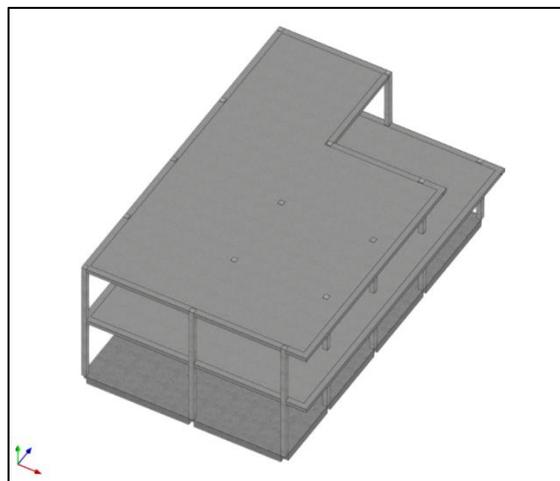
20. Recorte de pantalla, Vista 3D estructura en Cypecad
